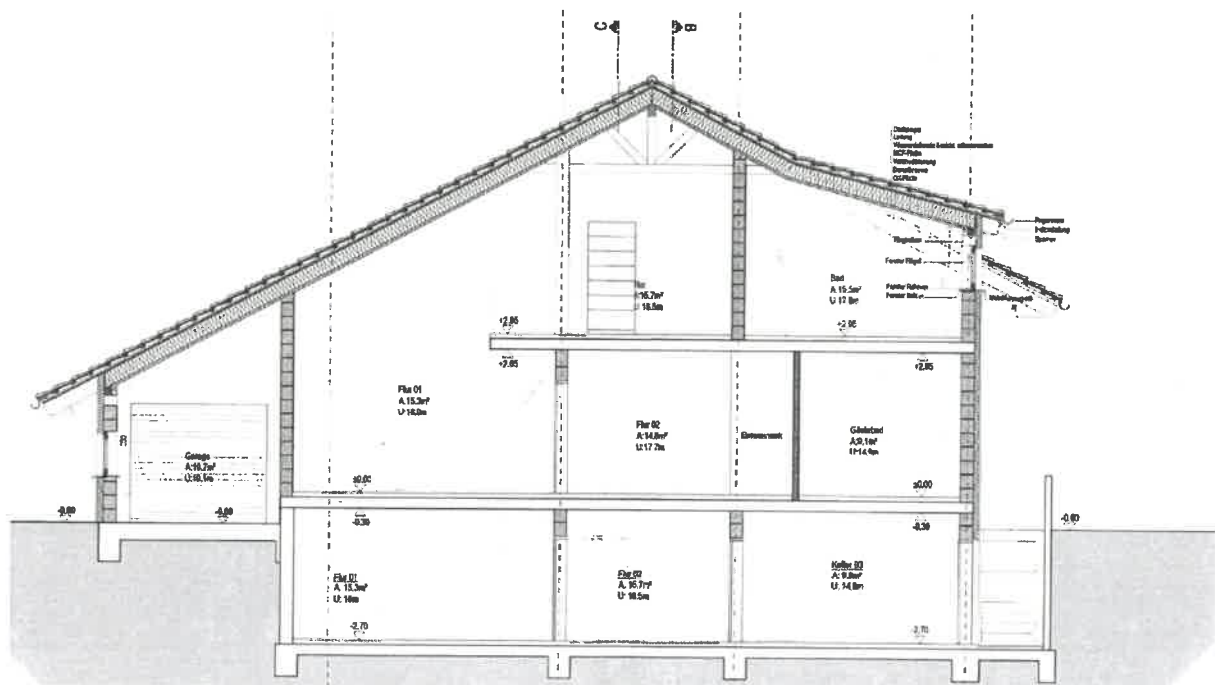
Auszug Bauantrag vom 31.08.2020, Schnitt Nord-Süd mit Darstellung der geplanten Gaube
